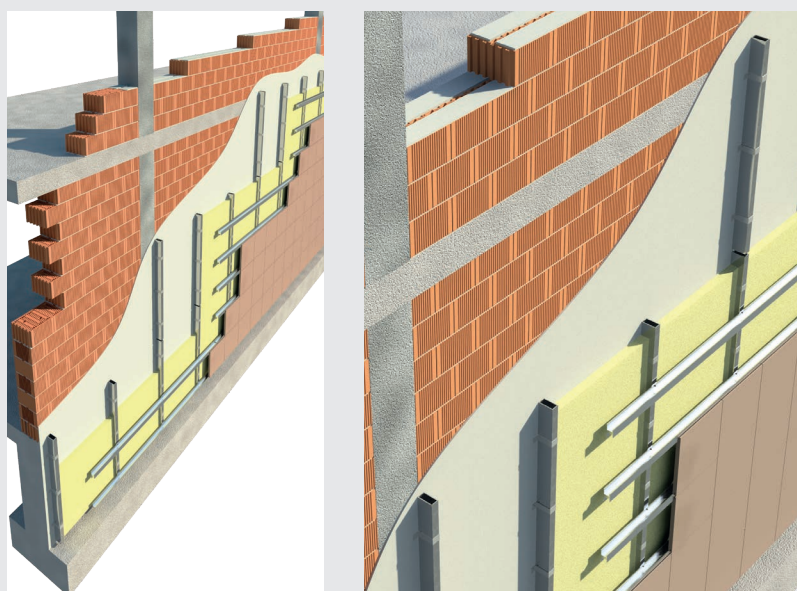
Fachada ventilada con subestructura metálica fijada a una hoja principal de bloque Termoarcilla
